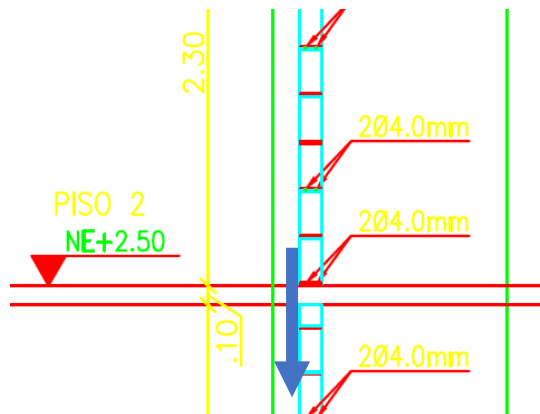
Esquema estructural muro-placa-muro, para Sistema estructural de muros de carga.
